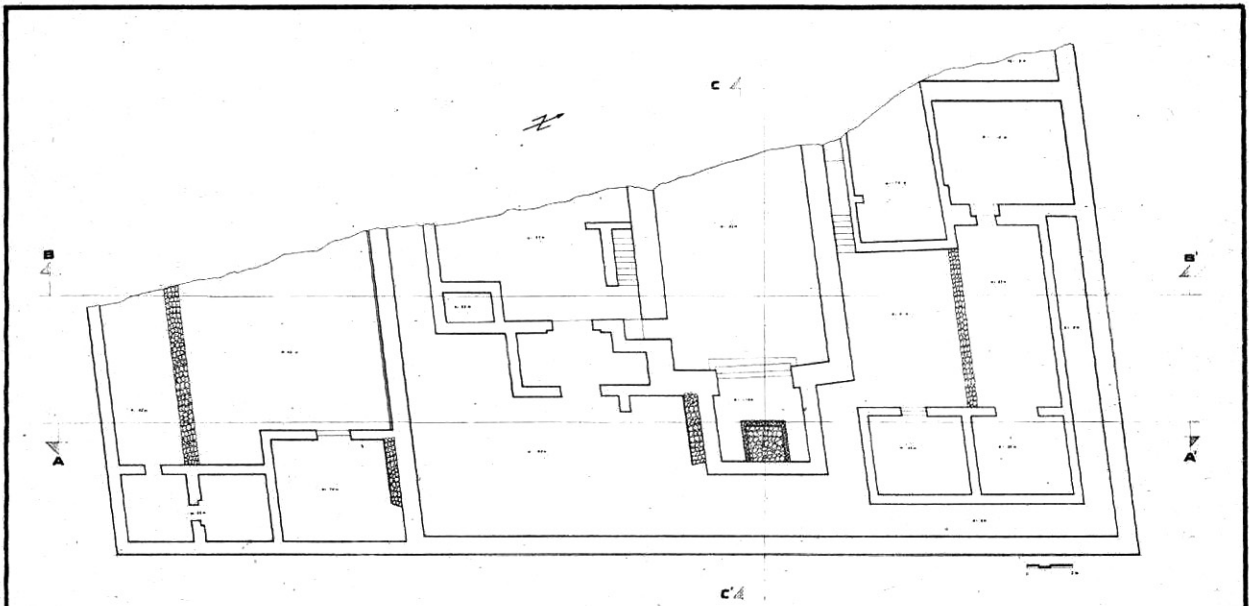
Planta Edificio 49. Levantó: Alejandro Arenas Villalón
